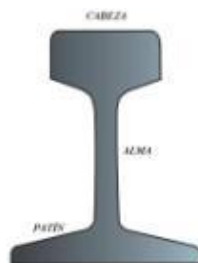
SECCION TRANSVERSAL DEL RIEL
